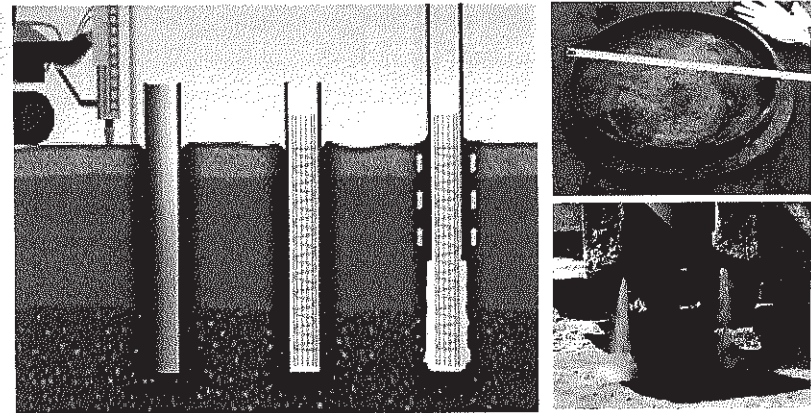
Etappen der Pfahlerstellung (links): Einvibrieren des Rohres, Einbau der Bewehrung, Betonieren mit Herausziehen des Rohres
